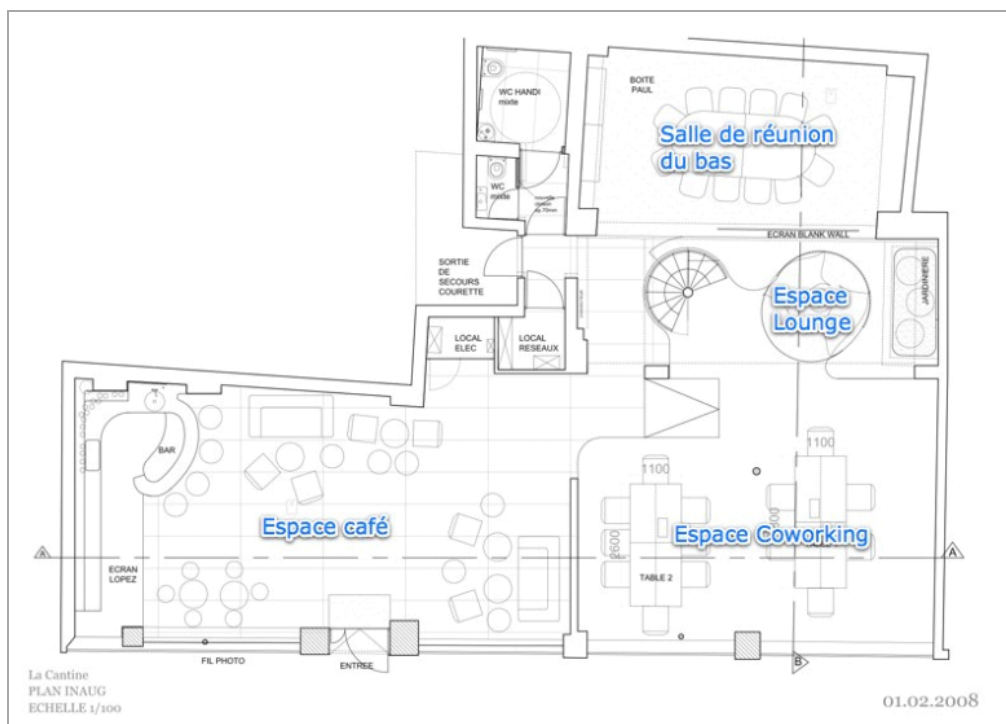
Plan de La Cantine²¹⁴ [Silicon Sentier, 2008]
